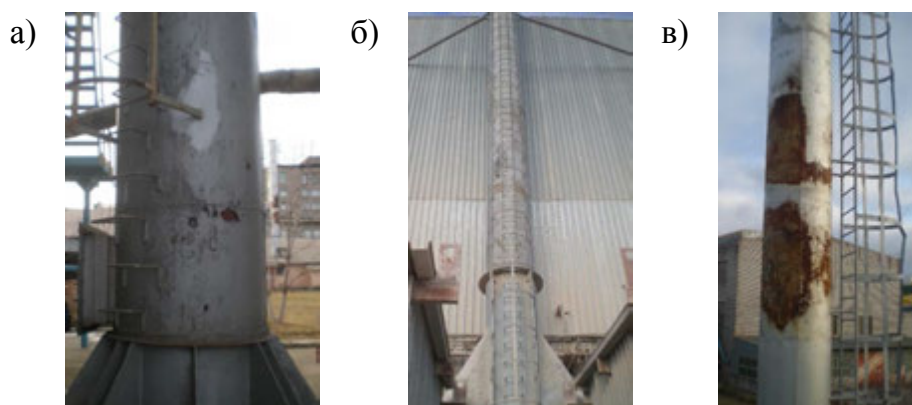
Коррозия стволов и разрушение защитного лакокрасочного покрытия: а) дымовой трубы газоочистки печи КС-55;
